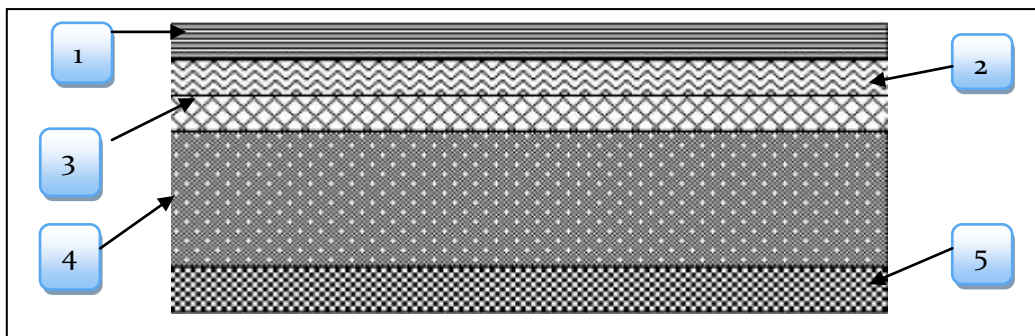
Coupe transversale dans le plancher à dalle pleine(BALCON)
